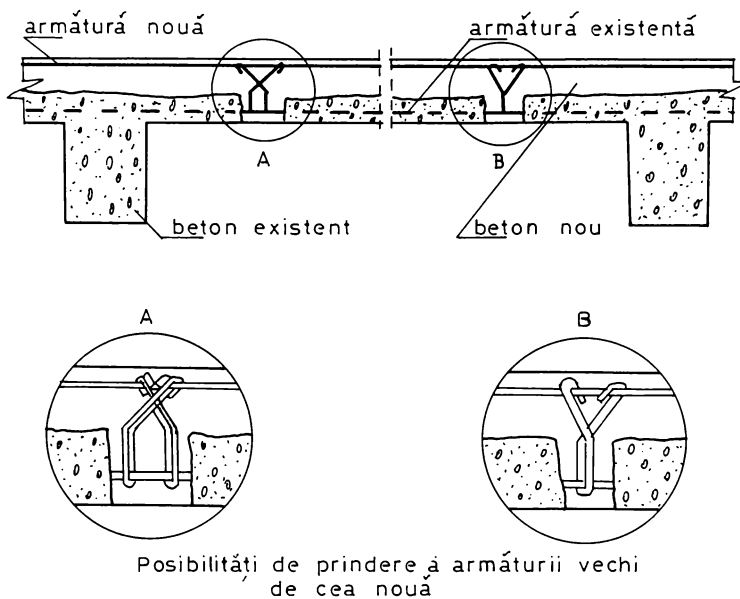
Consolidarea plăcilor de beton armat cu asigurarea legăturilor între bare
